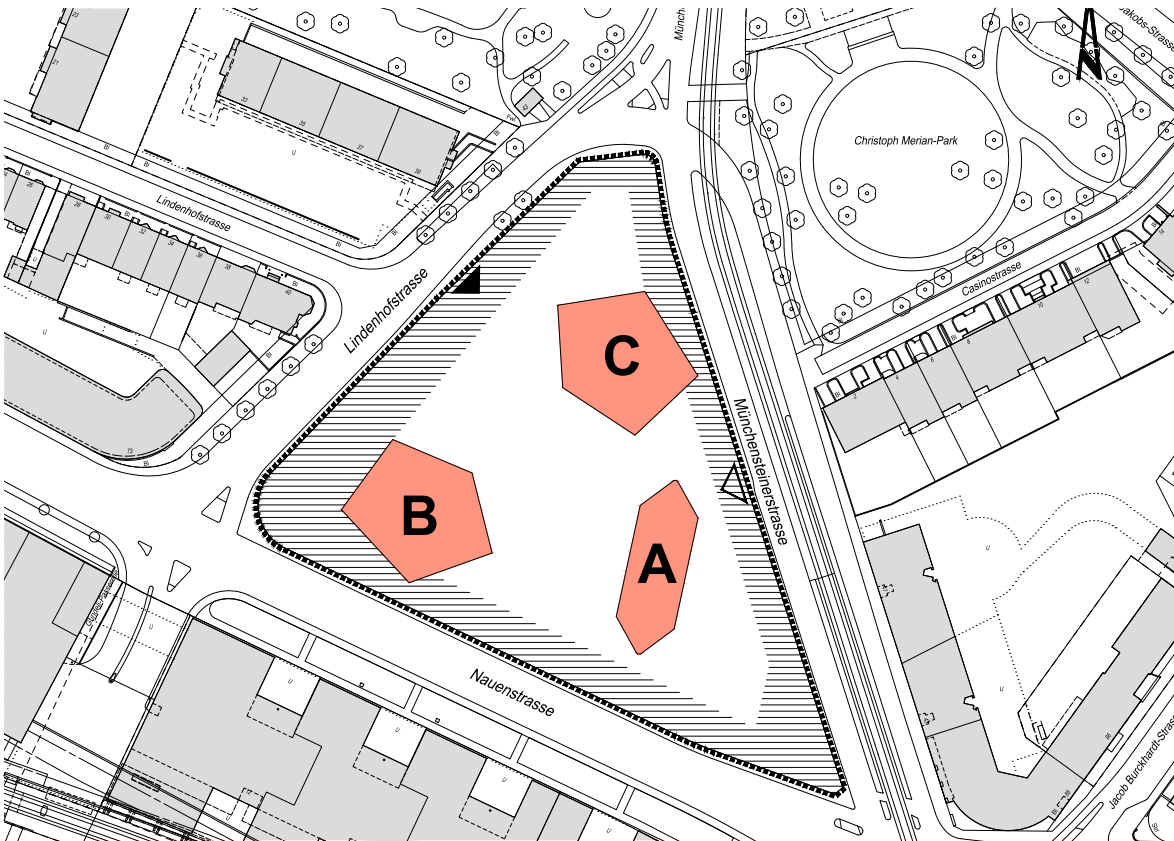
Darstellung Projektperimeter mit Baufeldern
